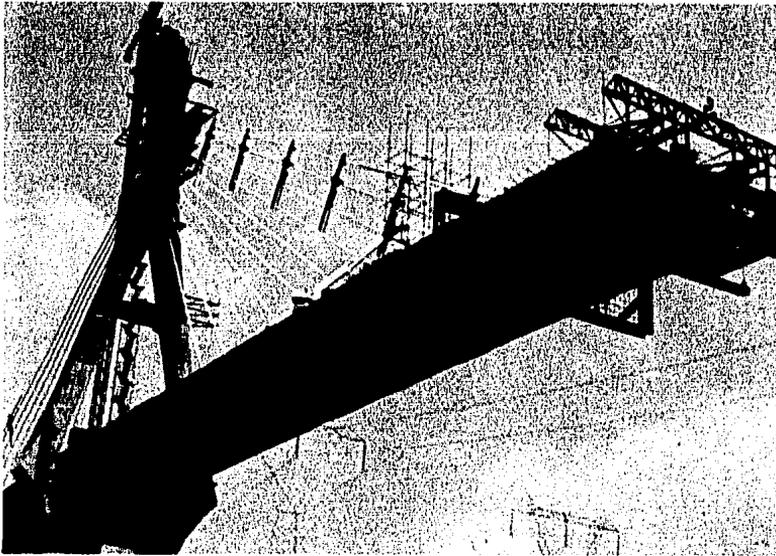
CONSTRUCCION DEL TRAMO ATIRANTADO.
